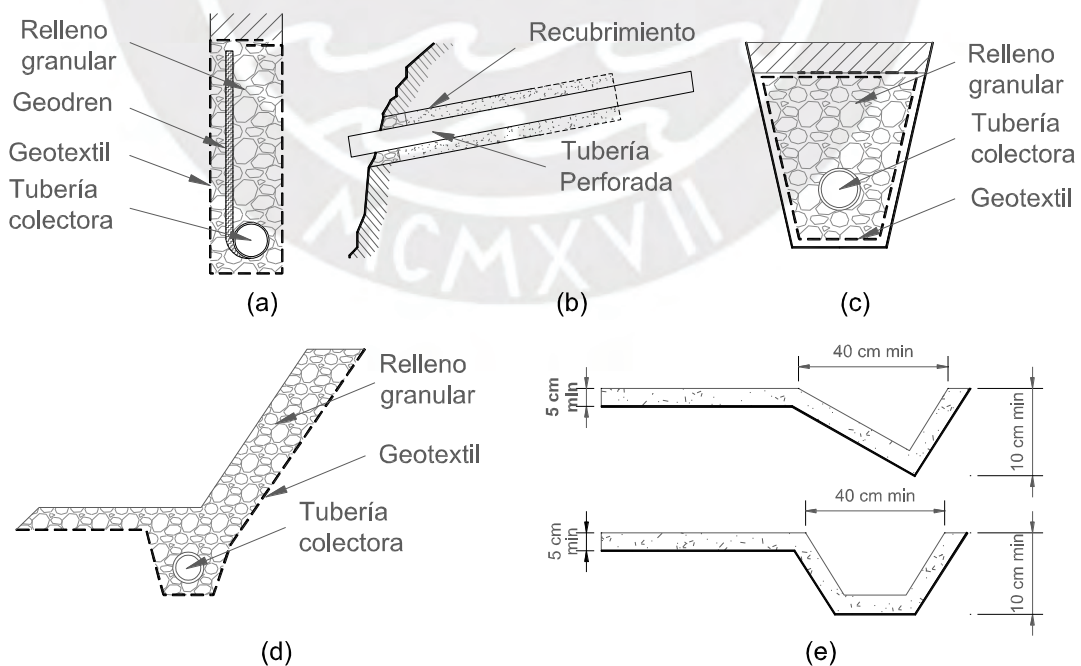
Sistemas de drenaje: (a) Subdrén para estructura de contención (b) Subdrén horizontal (c) Subdrén tipo zanja (d) Subdrén tipo pantalla y colchón de drenaje (e) Drenaje superficial de coronación y cuneta tipo zanja.
